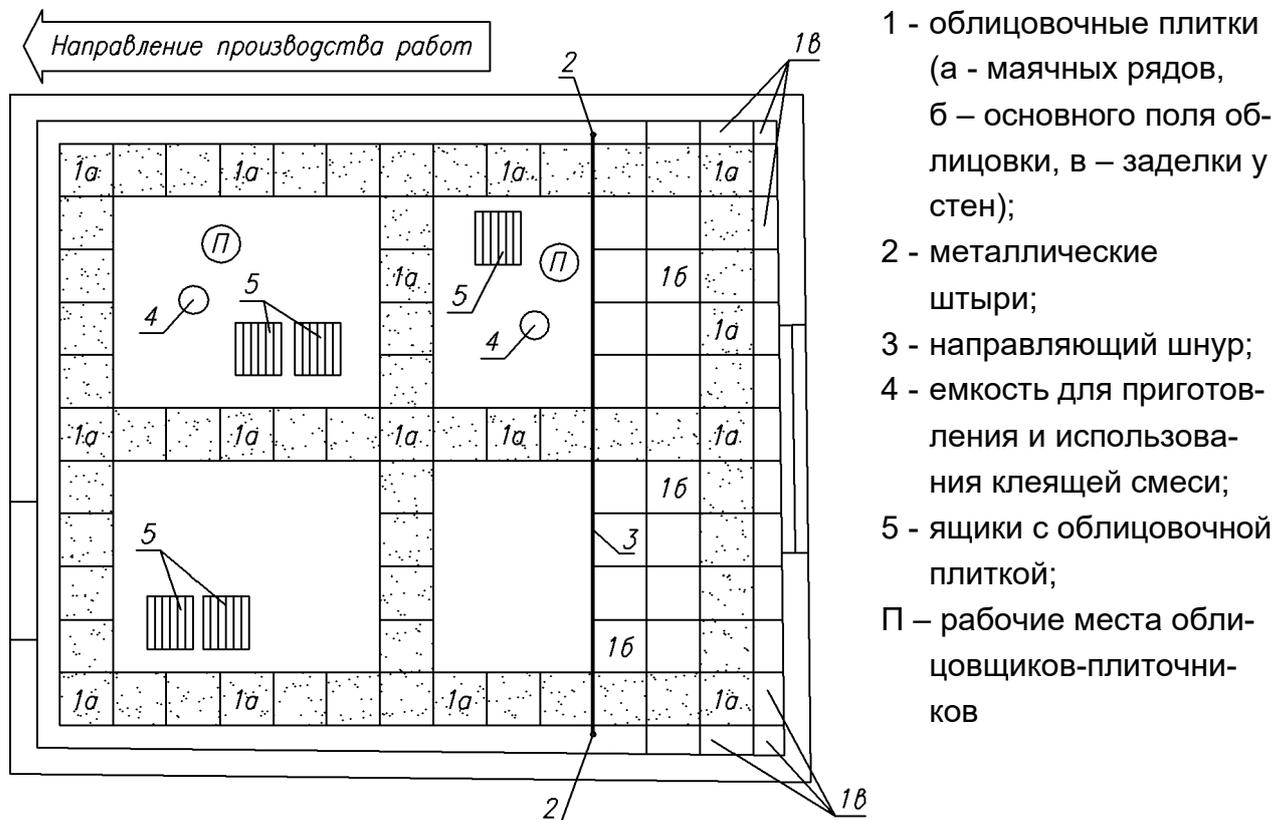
Схема организации работ при устройстве облицовочных покрытий полов
